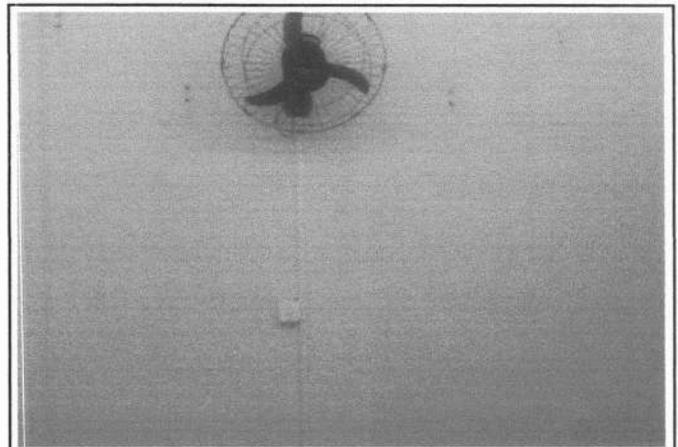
EMBUTIR INSTALAÇÕES APARENTES
